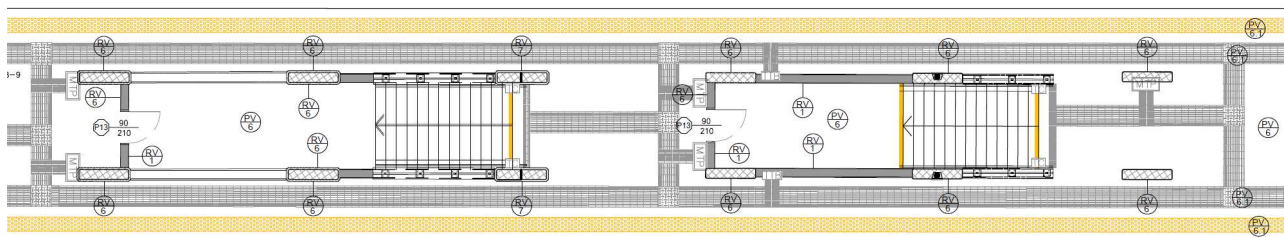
Dettaglio Pianta Piano Banchine esistente con indicazione delle finiture e dei materiali di progetto
